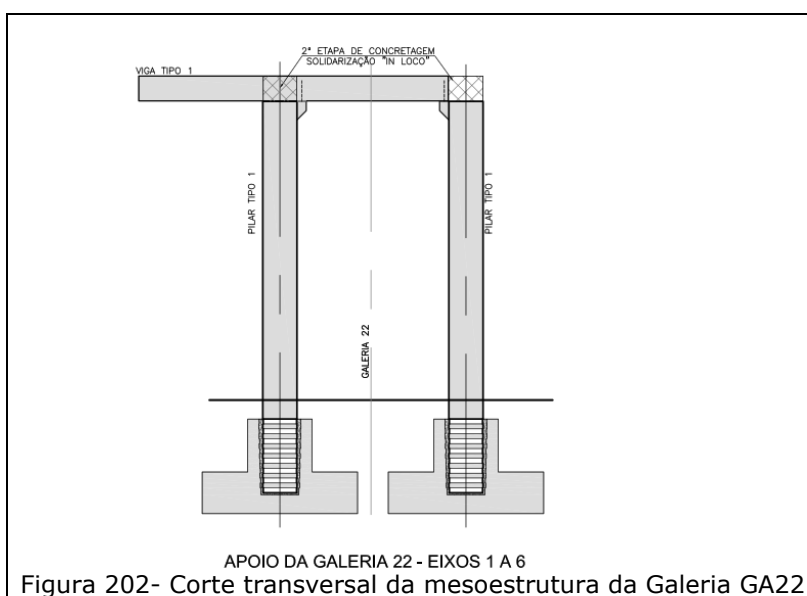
Corte transversal da mesoestrutura da Galeria GA22
